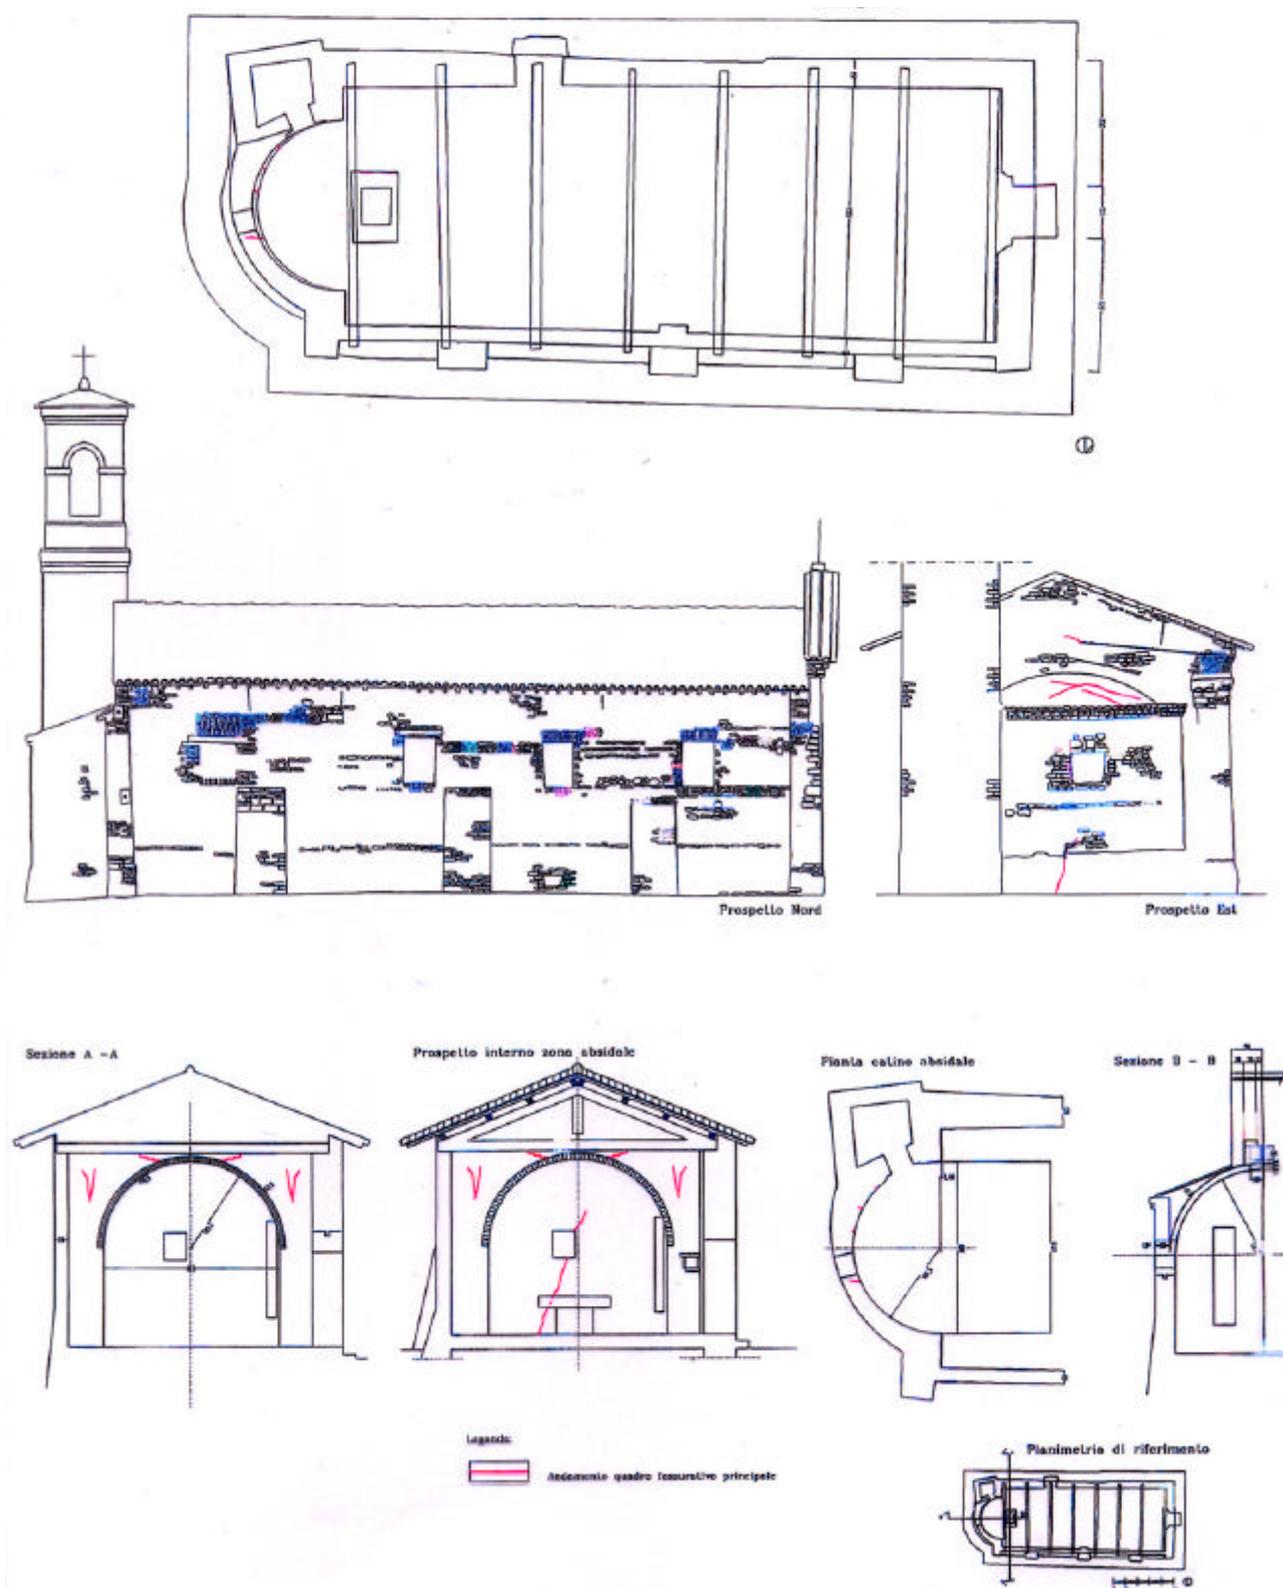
Borghetto di Villa del Conte: chiesa di San Massimo. Piante, prospetti, sezioni.
